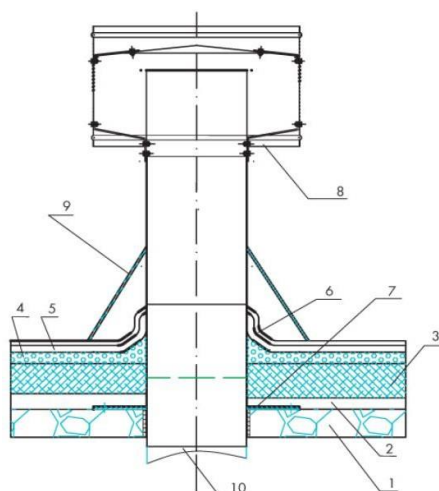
Схема вентиляционного узла мусоропровода: 1) плита перекрытия; 2) пароизоляция; 3) теплоизоляция; 4) выравнивающая стяжка с бортиком из цементнопесчаного раствора; 5) основной водоизоляционный слой; 6) дополнительные слои водоизоляционного кровельного материала; 7) гильза; 8) дефлектор; 9) фартук; 10) труба вентиляционная
